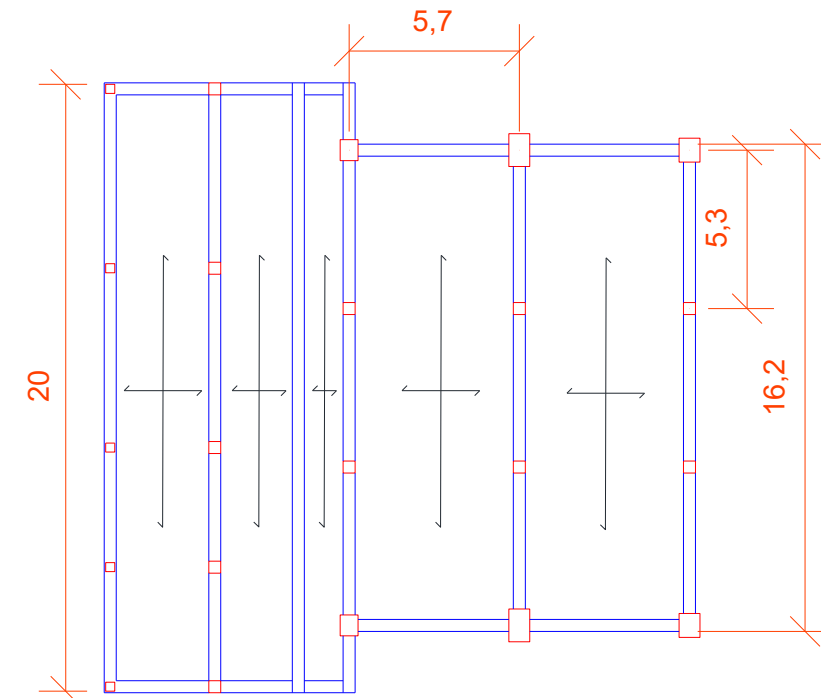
Vista en planta de las losas que forman el graderío.
